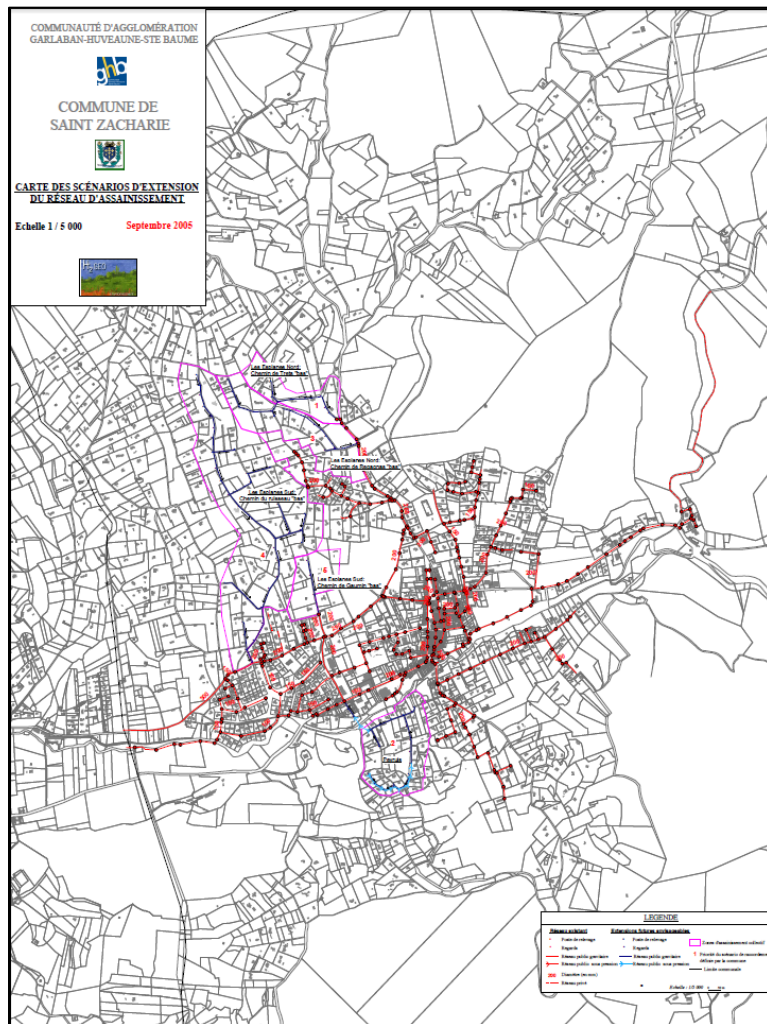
Plan de situation de la collecte – Saint-Zacharie
